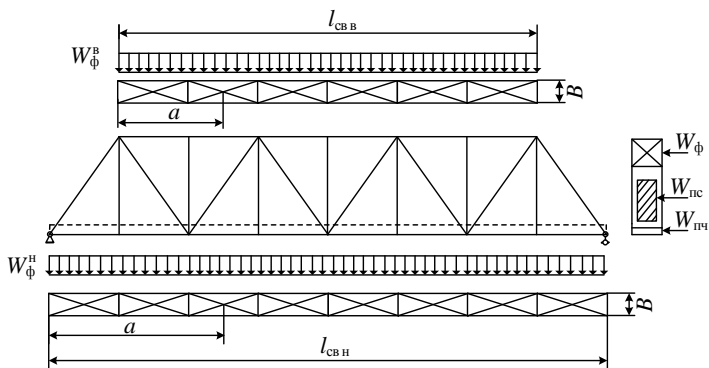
Схема пролетного строения для определения усилий в элементах конструкций от ветровой нагрузки
